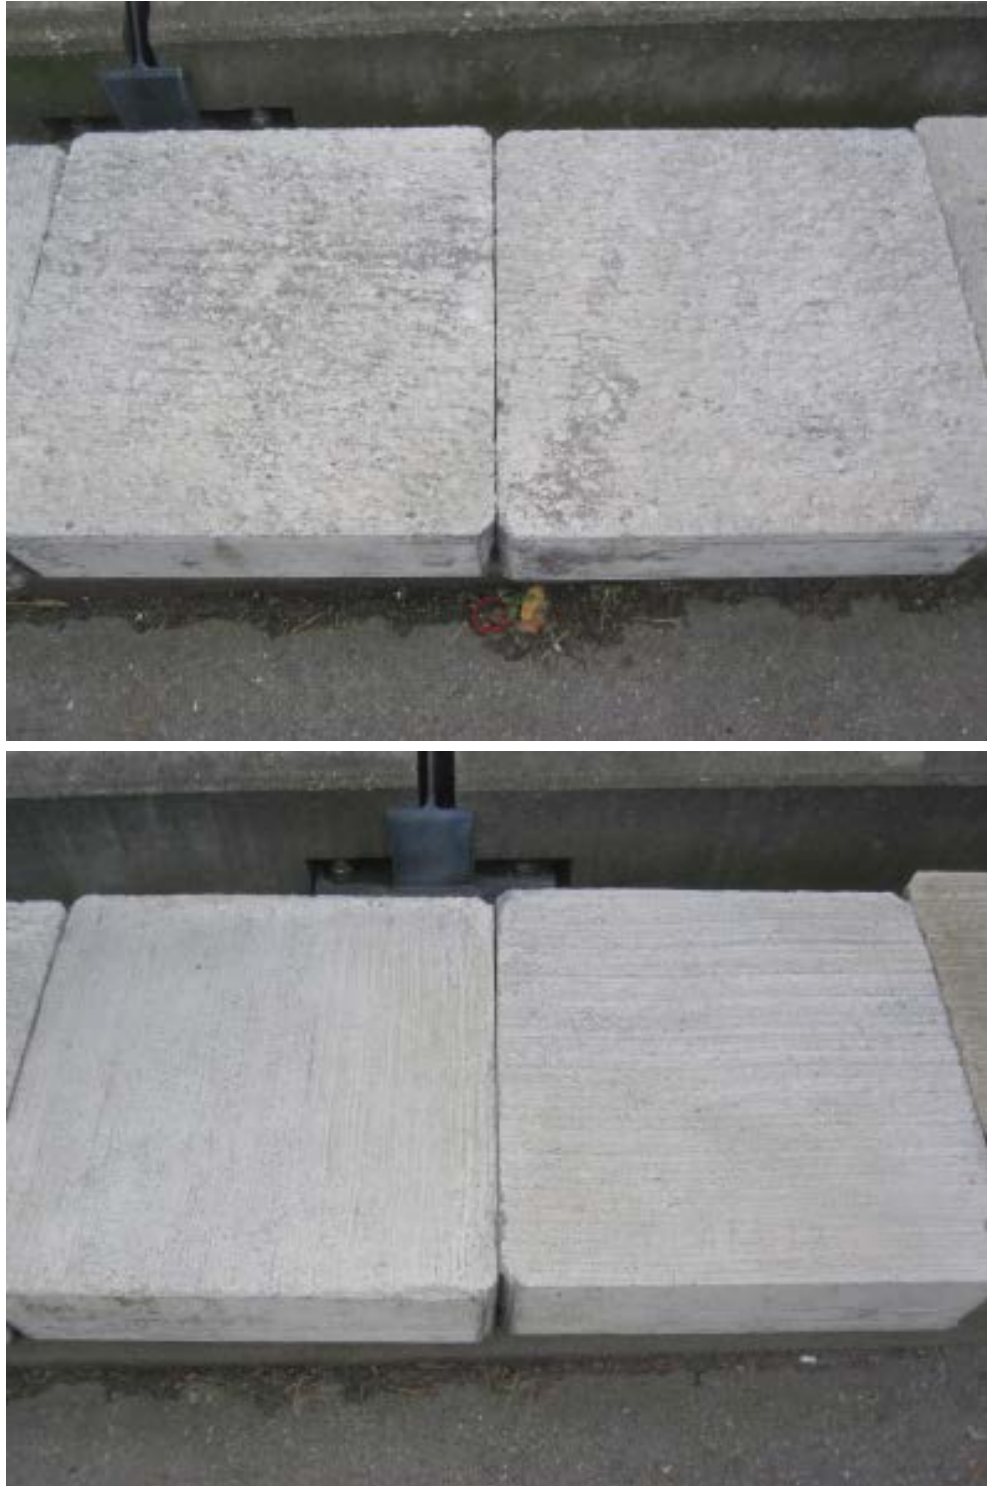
Zustand der Versuchsplatten am 18.10.2013. Oben: Beton 5. Unten: Beton 12
